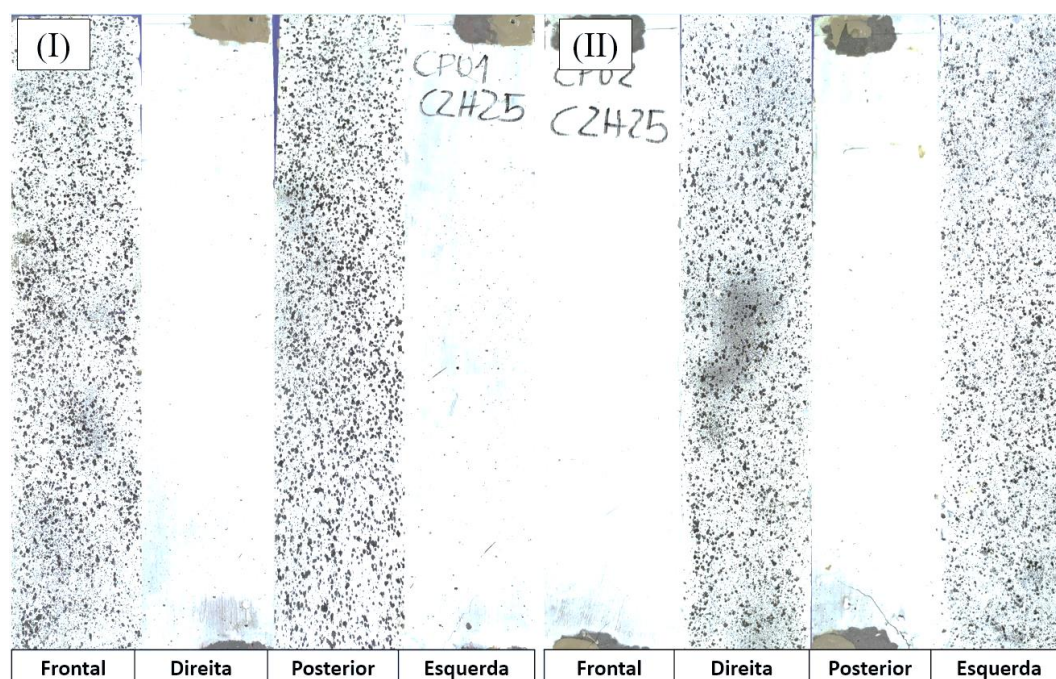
Mapas de fissuras do grupo C1.V.25.
